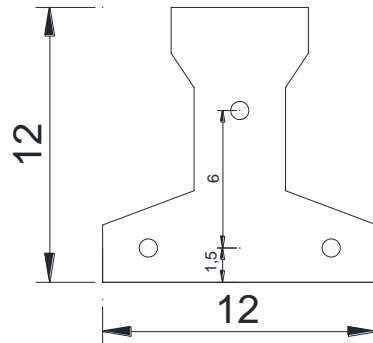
SECCIÓN HOMOGENEIZADA PARA HORMIGÓN
